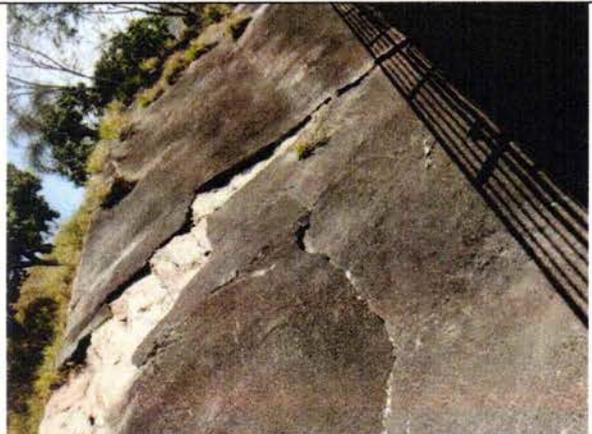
O revestimento de argamassa de concreto, jateado, lançado sobre o solo, com assentamento de tela metálica, existente, foram perdidos pela ação do deslizamento;
